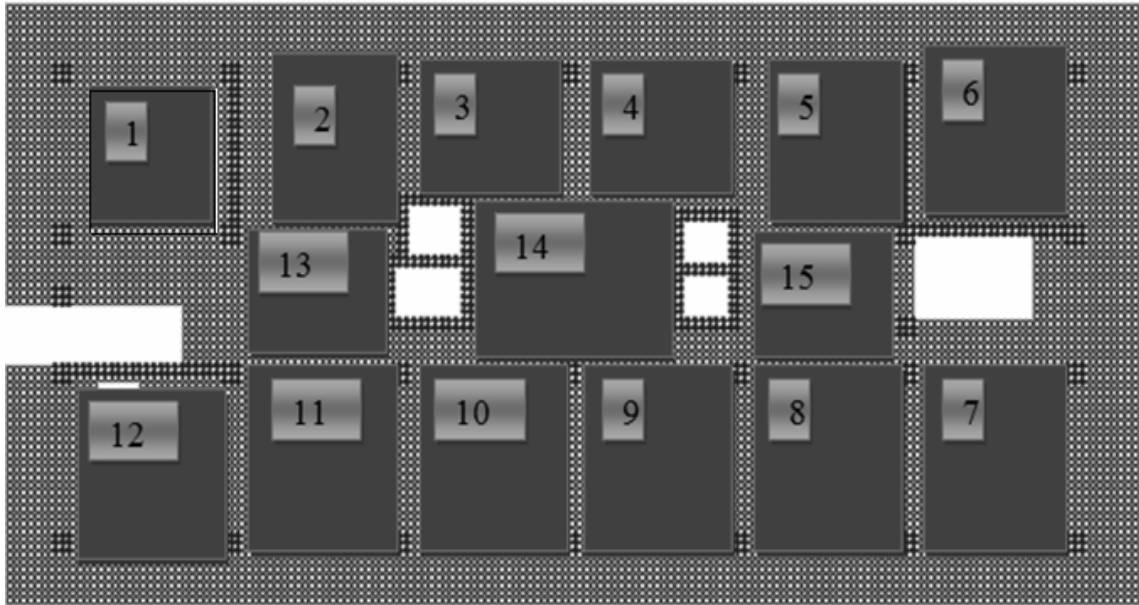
Расчетная схема перекрытия с размещением на ней источников пожара.
